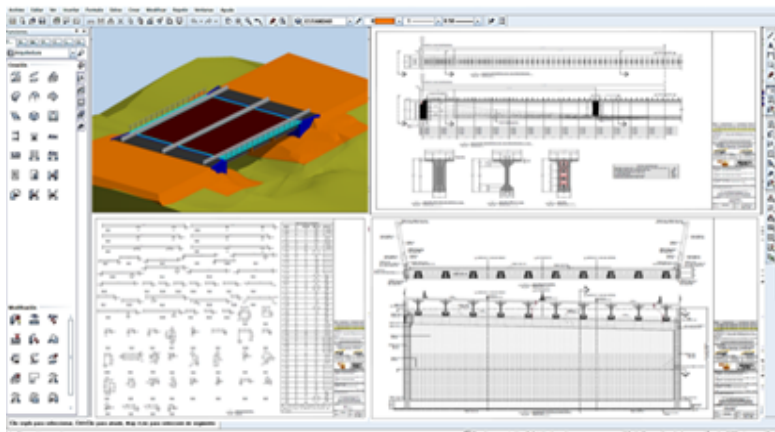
Modelo BIM de un Puente y la Planimetría obtenida del mismo.
